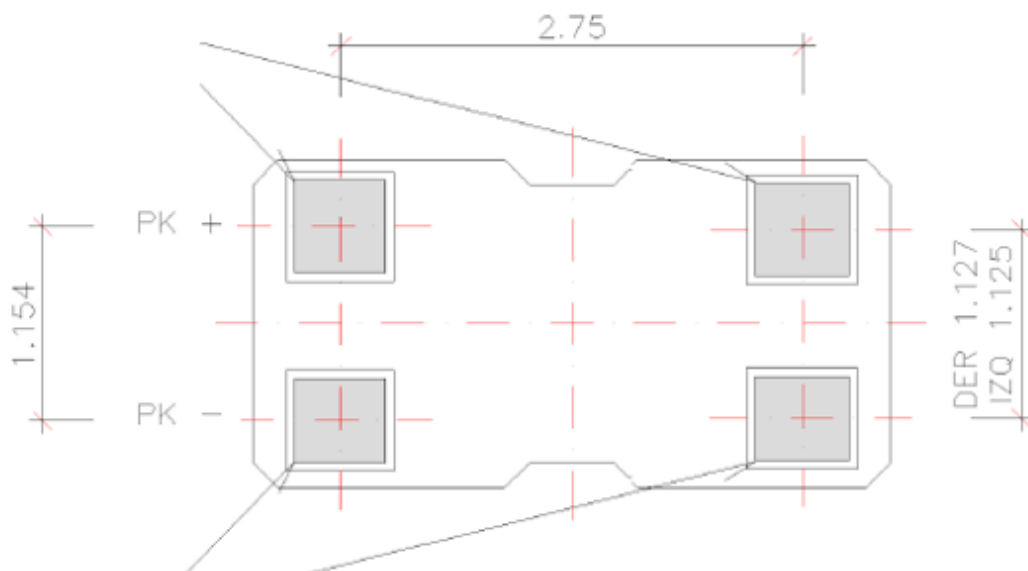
Distancia entre centros de gravedad de los apoyos (Fuente: Planos anteproyecto)
